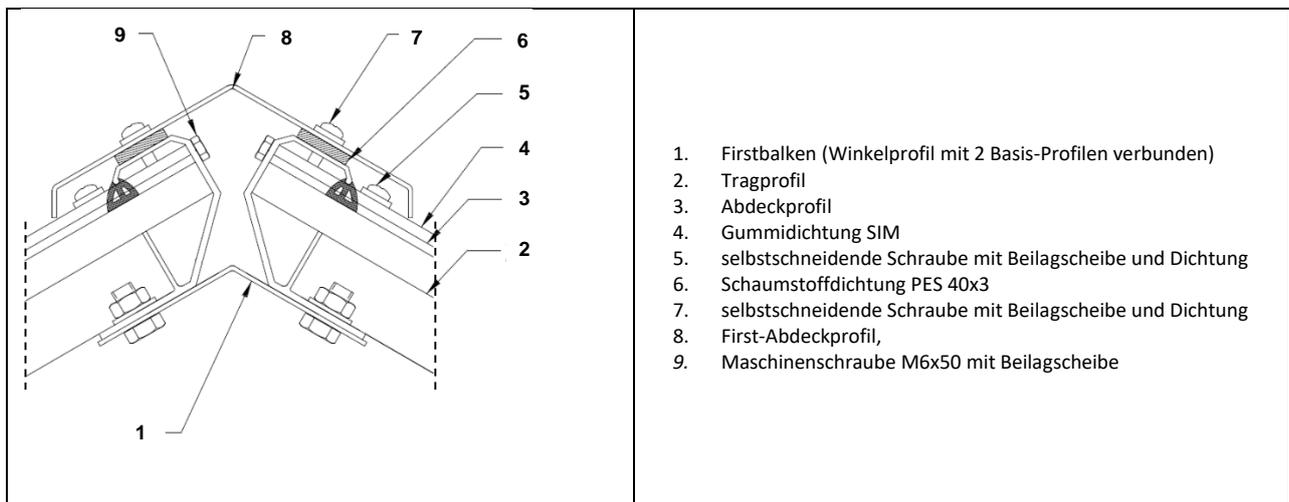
Schnitt durch eine korrekte Montage einer satteldachförmigen Lichtbandkonstruktion
